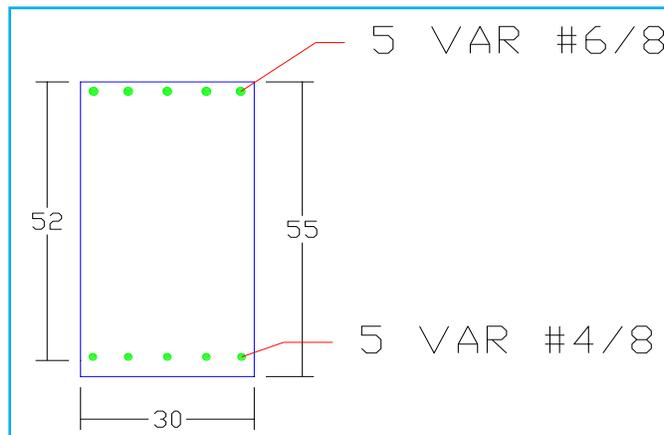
área de acero calculada para los primeros 17 metros de la viga a partir del apoyo empotrado.
